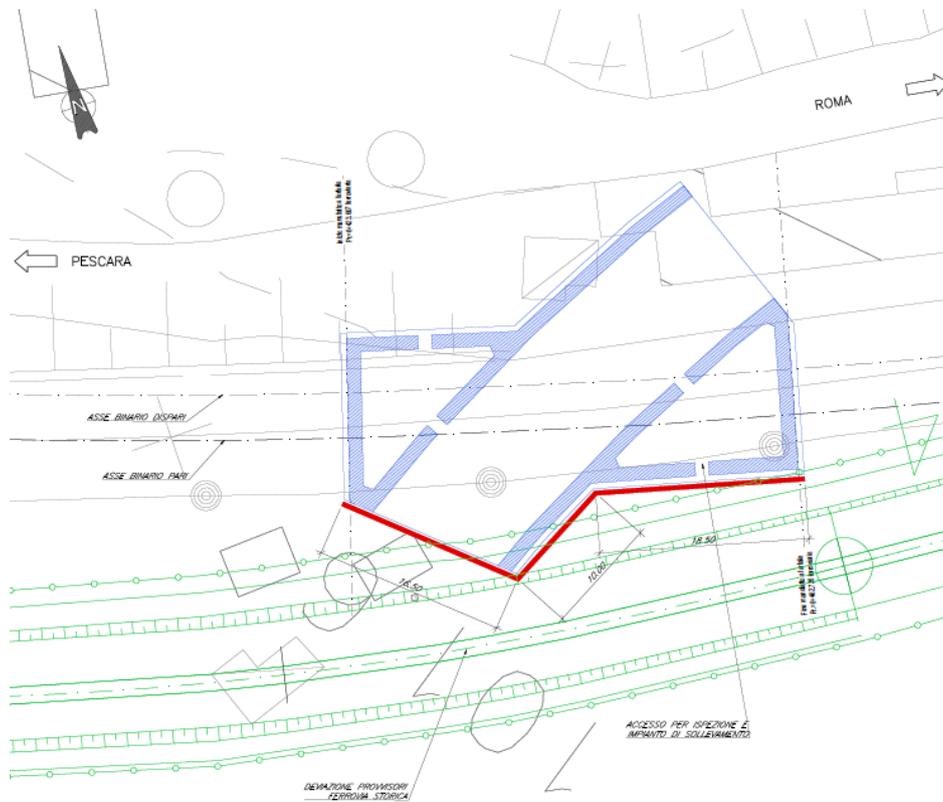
SL25 – Fasi realizzative 1 e 2, pianta sottopasso
